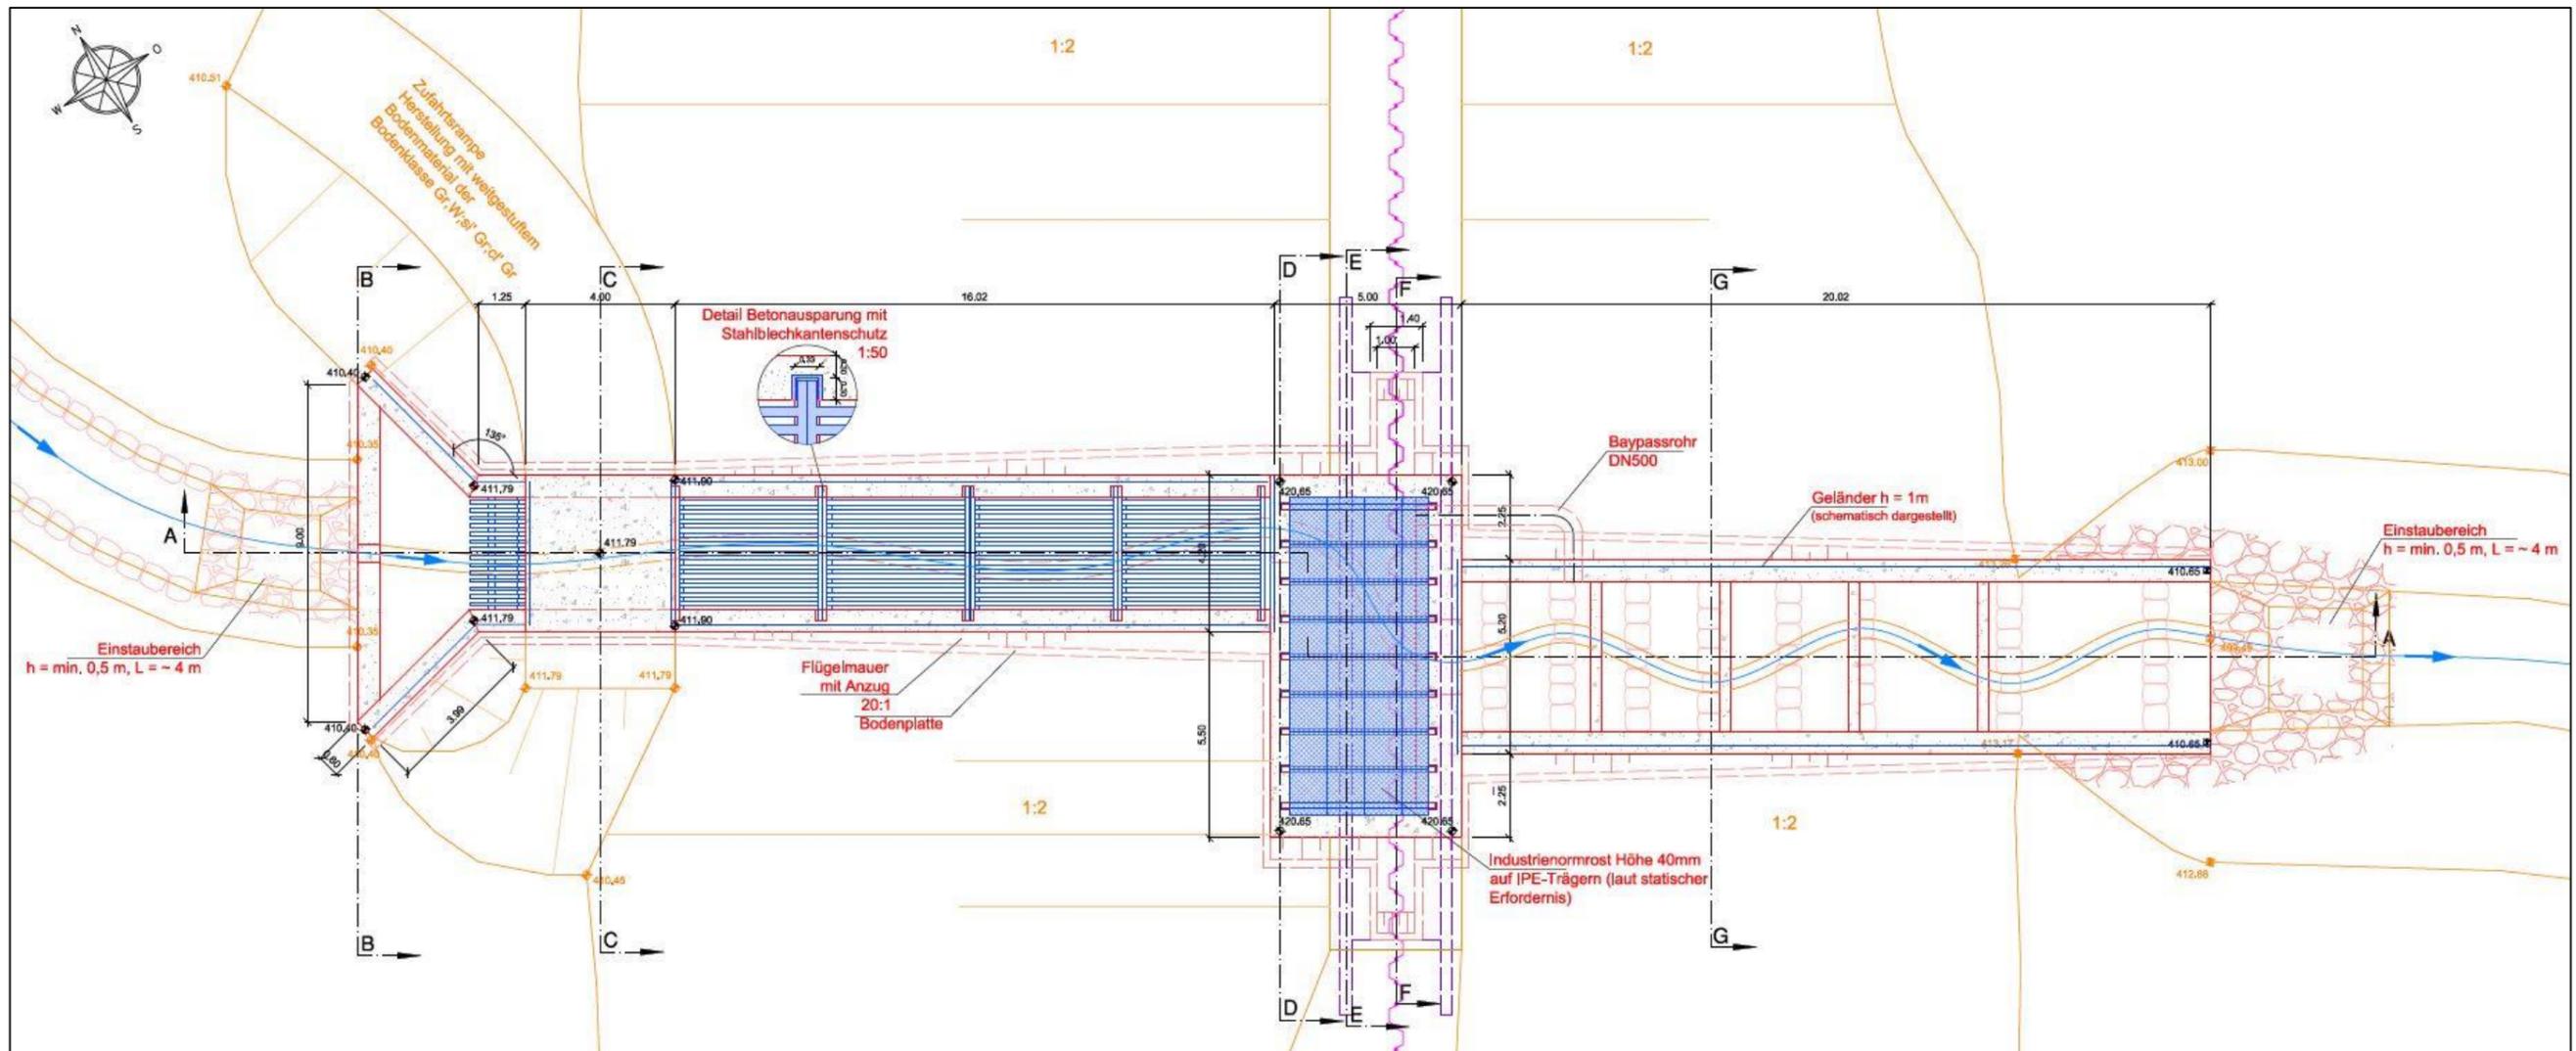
Draufsicht RHB Andritzbach (aus „Detail Grundablassbauwerk“) [Q8]
